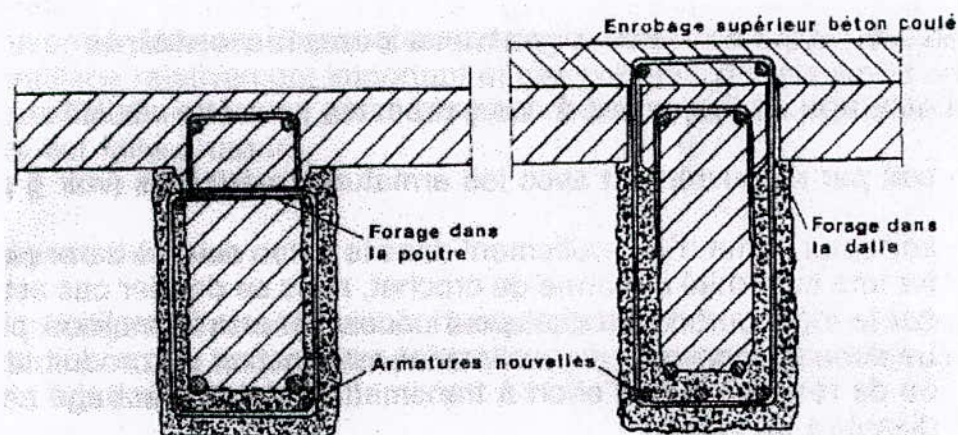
Armatures supplémentaires en surépaisseur de poutre
